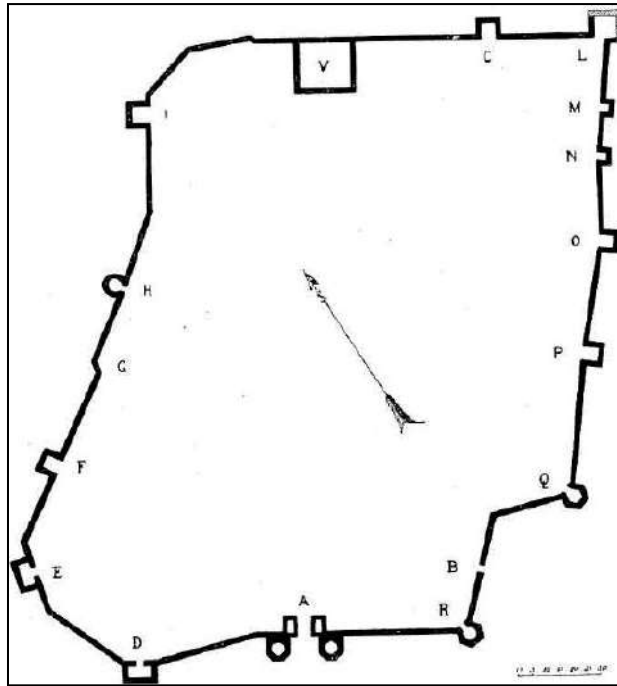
Plan de la place forte d'Ain el-Bordj
